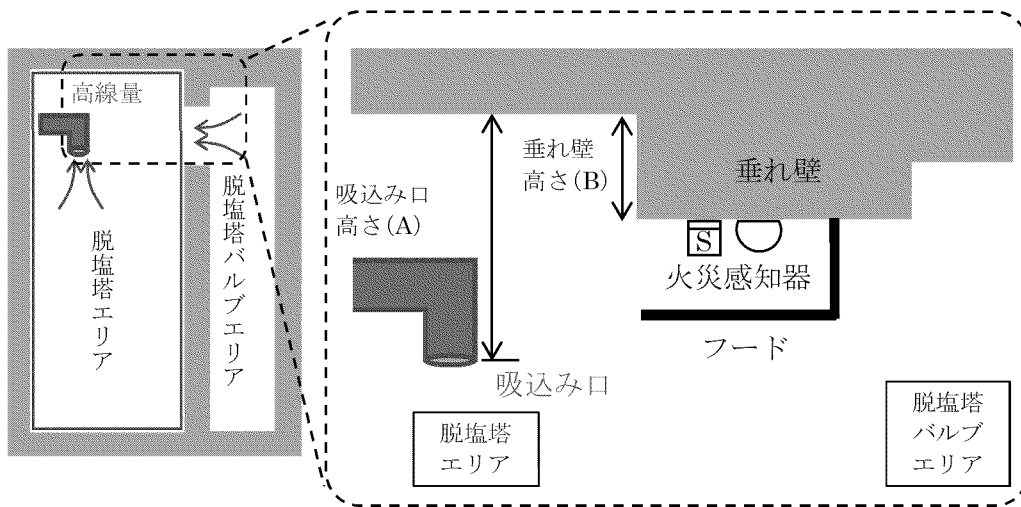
玄海 4 号機 脱塩塔エリアと脱塩塔バルブエリアの配置図（平面図）
